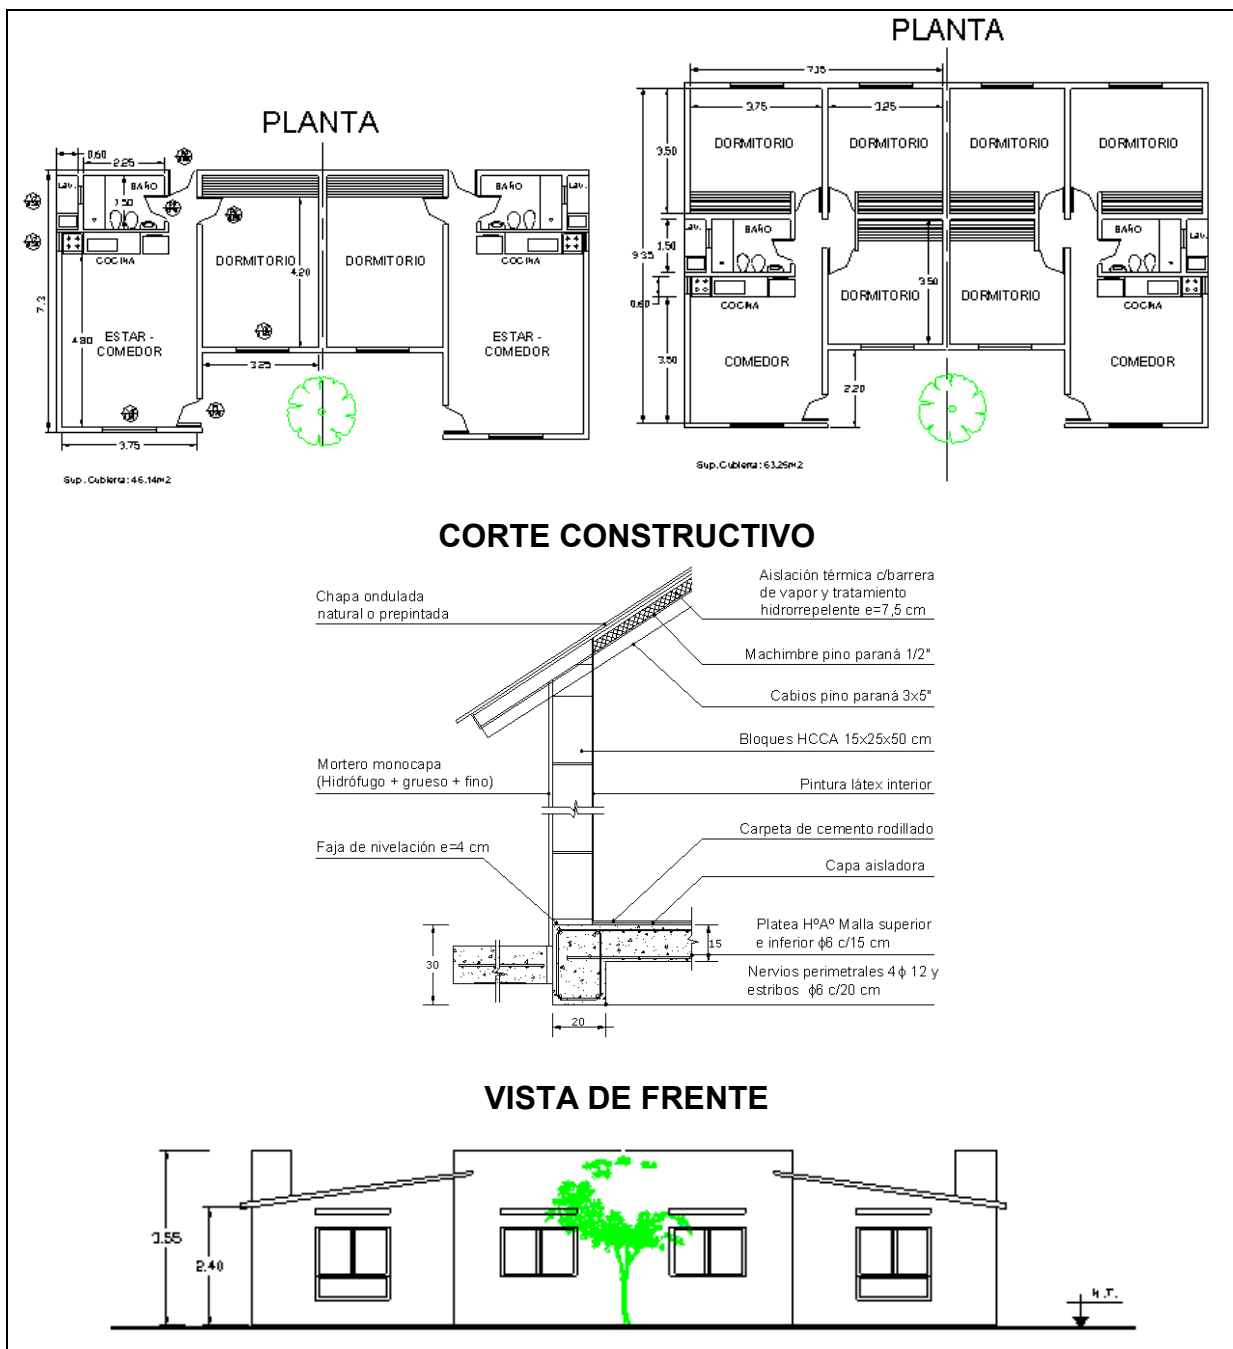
Plantas de prototipos de 1 y de 3 dormitorios, corte constructivo y vista de frente.
